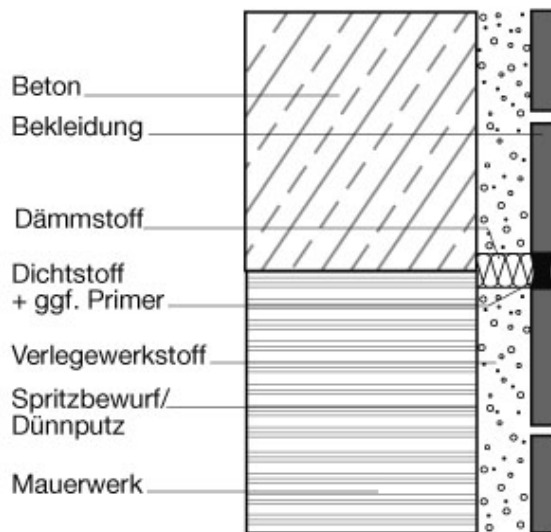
Feldbegrenzungsfuge in einer Fassadenbekleidung
